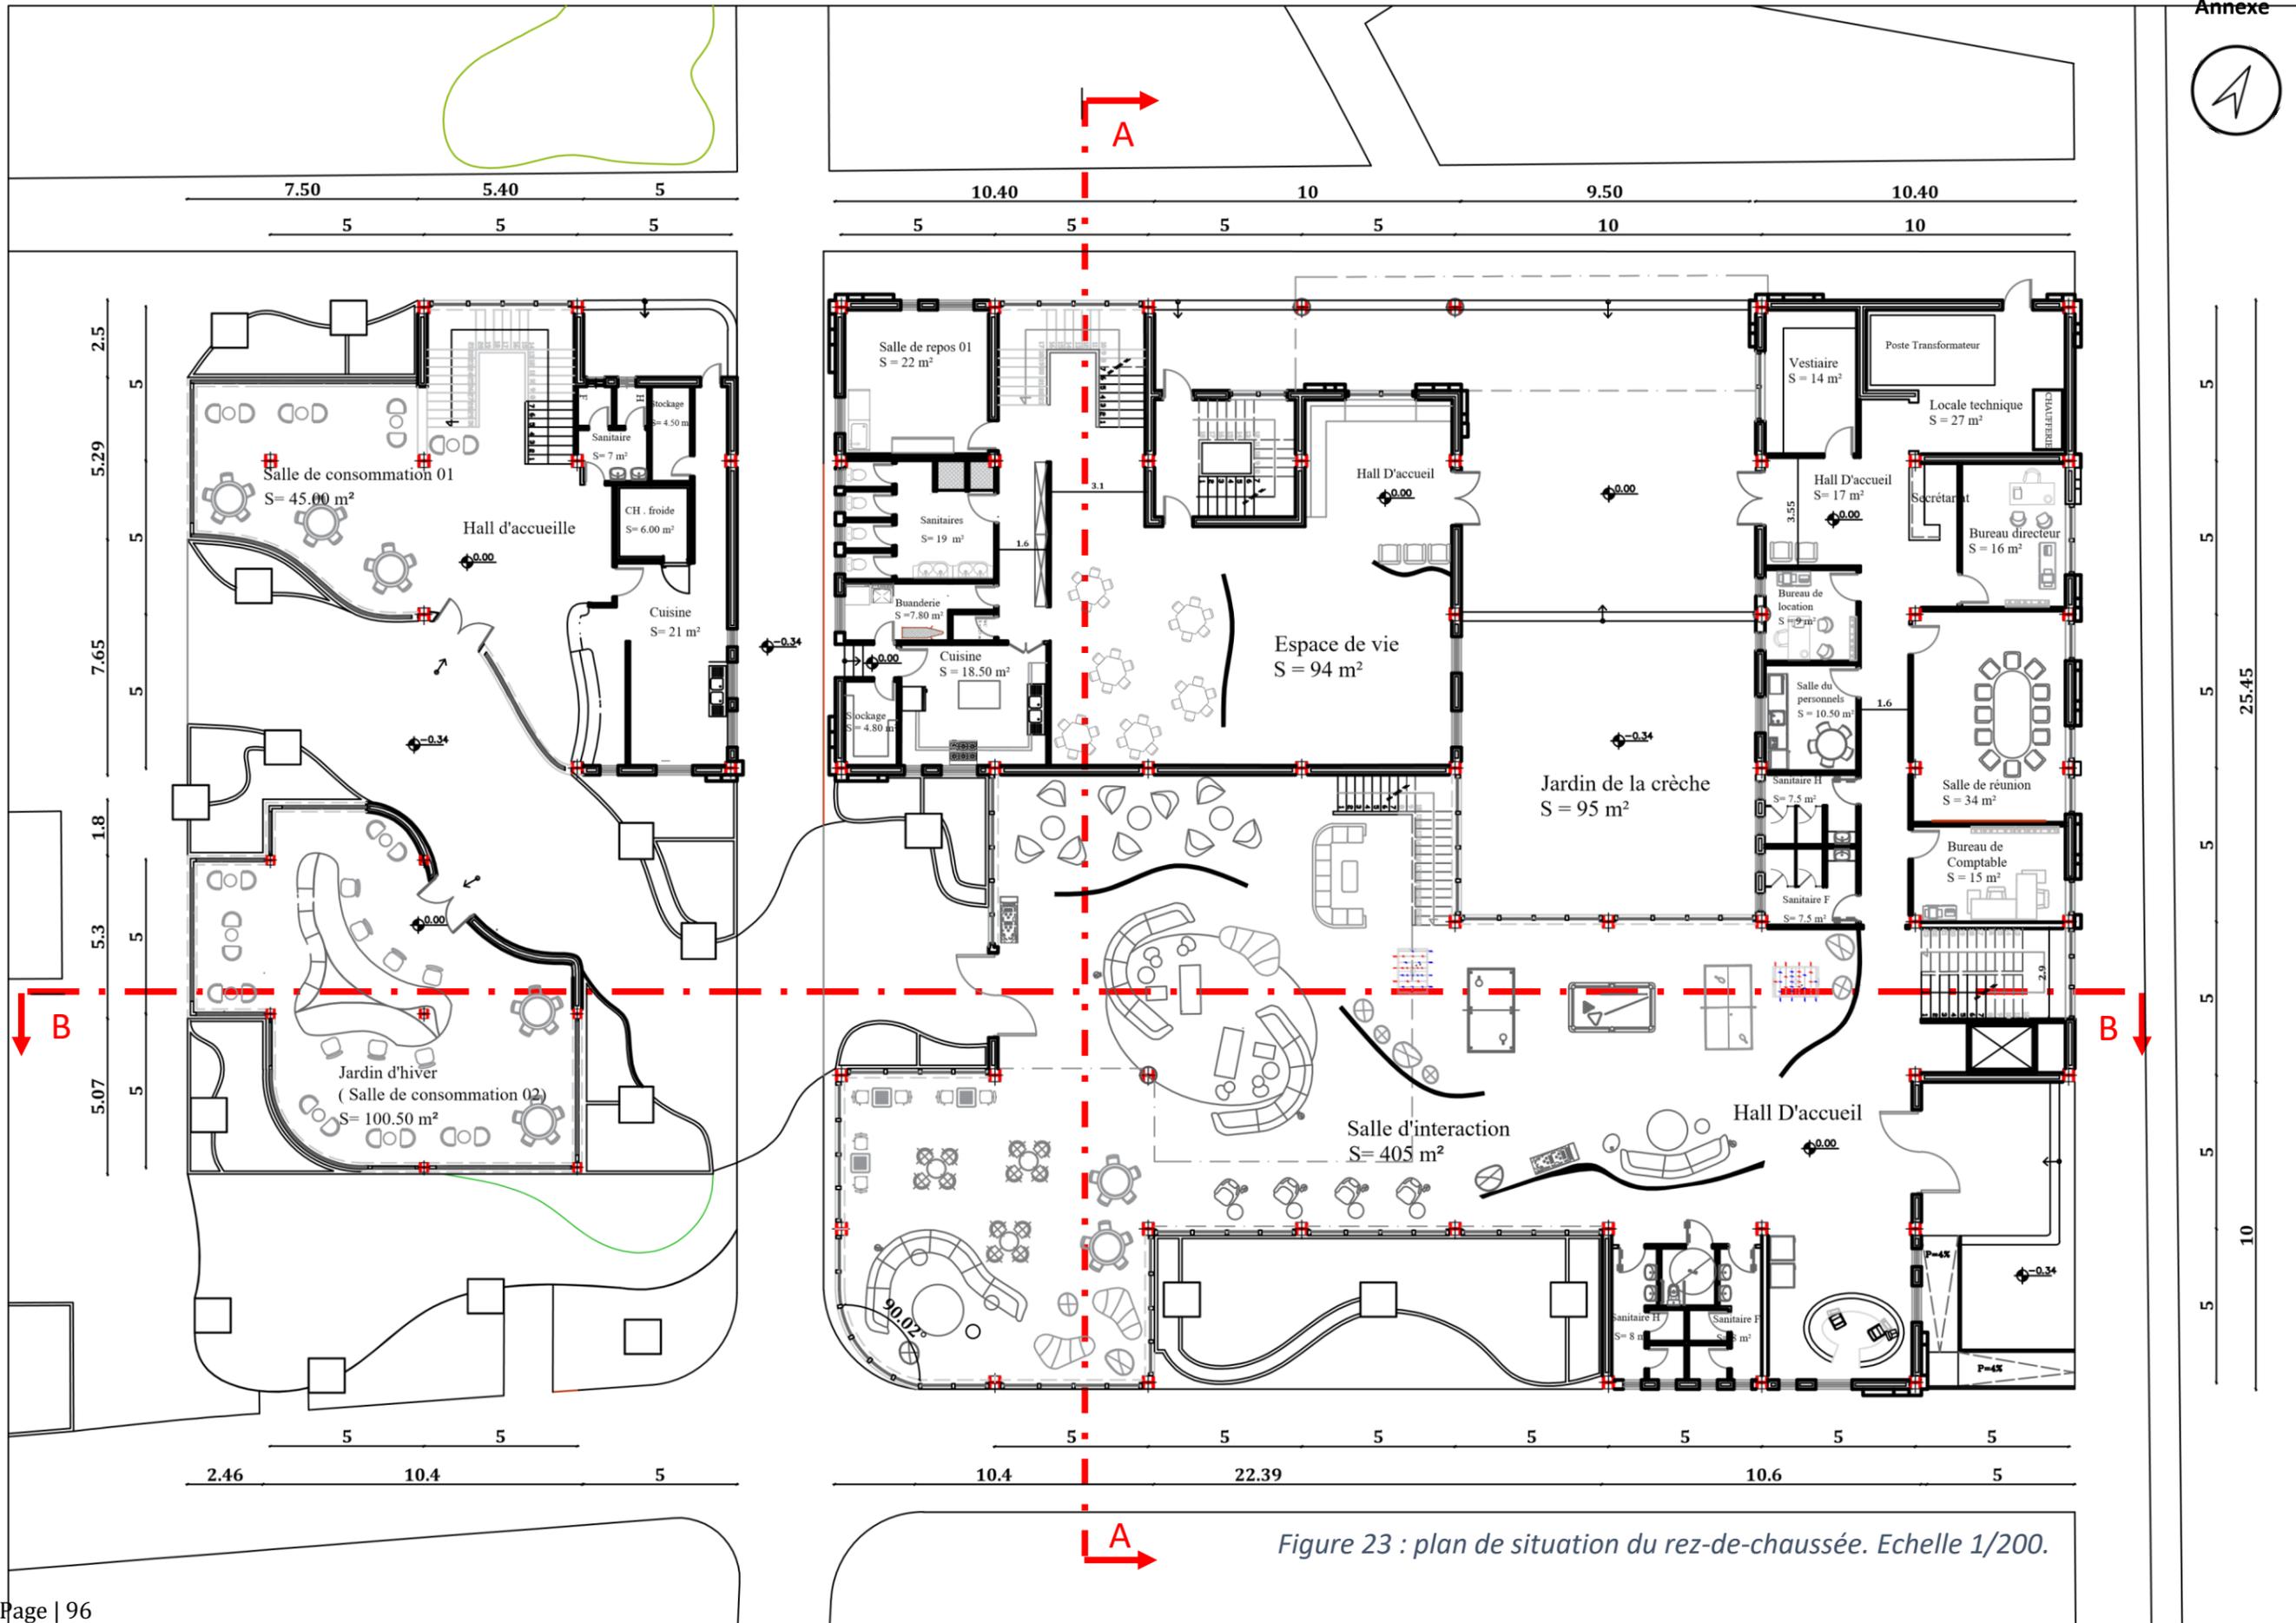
plan de situation du rez-de-chaussée. Echelle 1/200.
